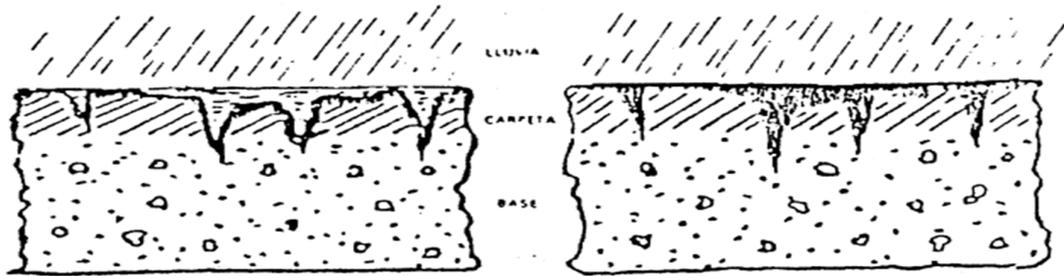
Sellado de fisuras o microfisuras e impermeabilización del pavimento
